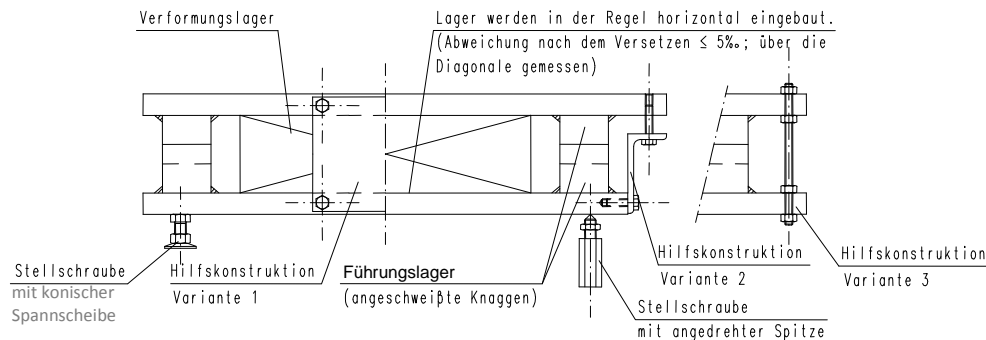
Seitenansicht eines Elastomerlagers kombiniert mit Führungslager nach DIN 4141-13 [6]
